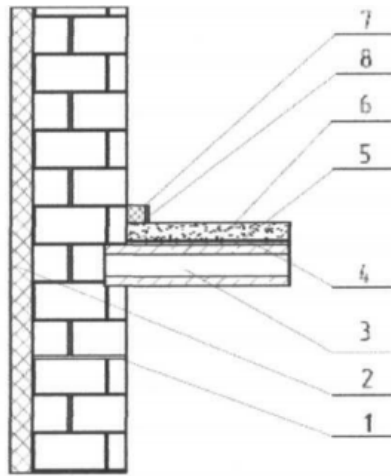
Загальна схема утепленню вузла примикання перекриття на горищі. 1- зовнішня стіна; 2 – теплоізоляційно-оздоблювальний шар; 3 – плита перекриття; 4 – пароізоляція; 5 – мінеральна плита; 6 – армована стяжка із цементно-піщаного розчину; 7 – утеплювач
